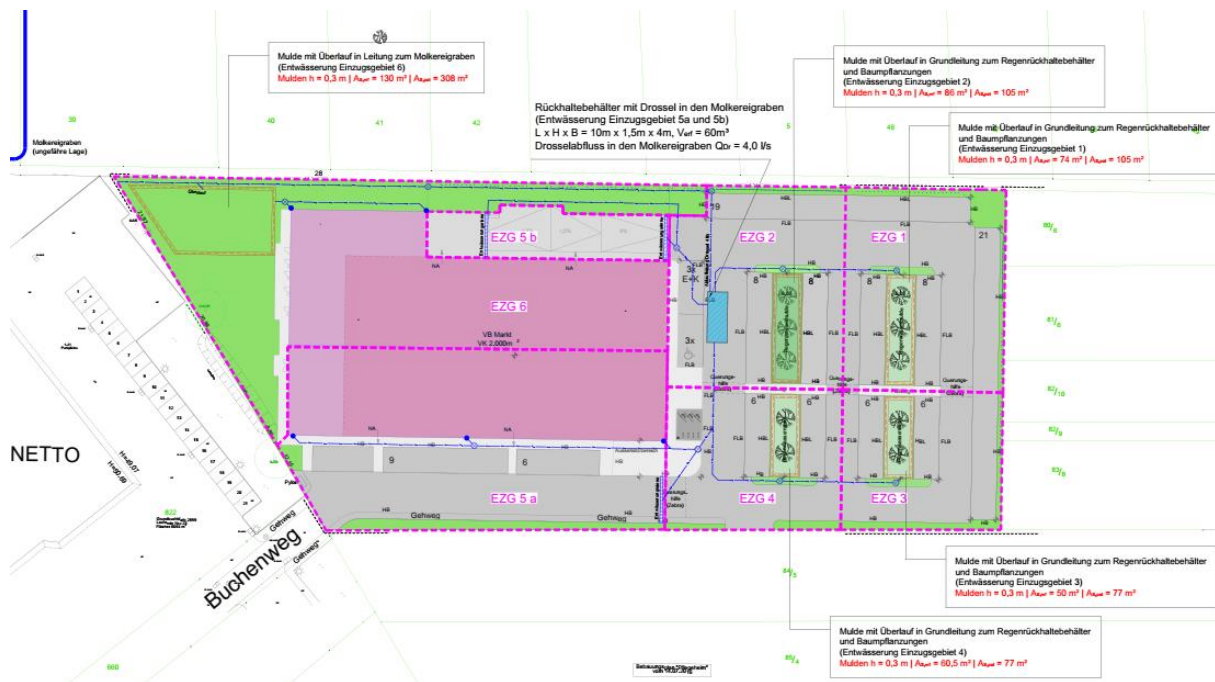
Lageplan Entwässerungskonzept HOFFMANN-LEICHTER, 16.08.2024
